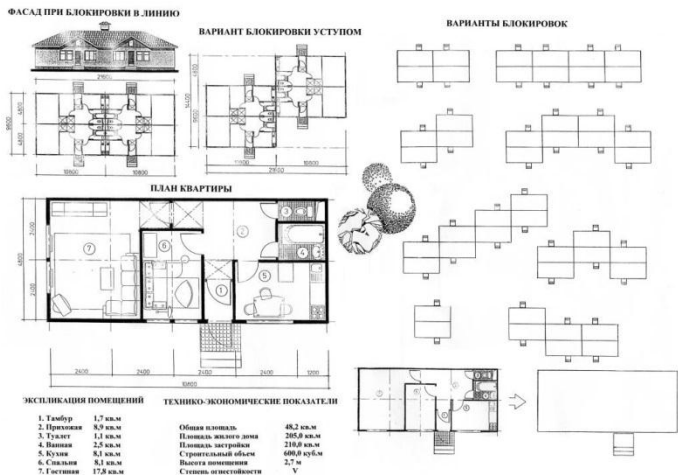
Блокированный быстровозводимый жилой дом общей площадью 48,2 кв.м. Фасады, план, варианты блокировок.
